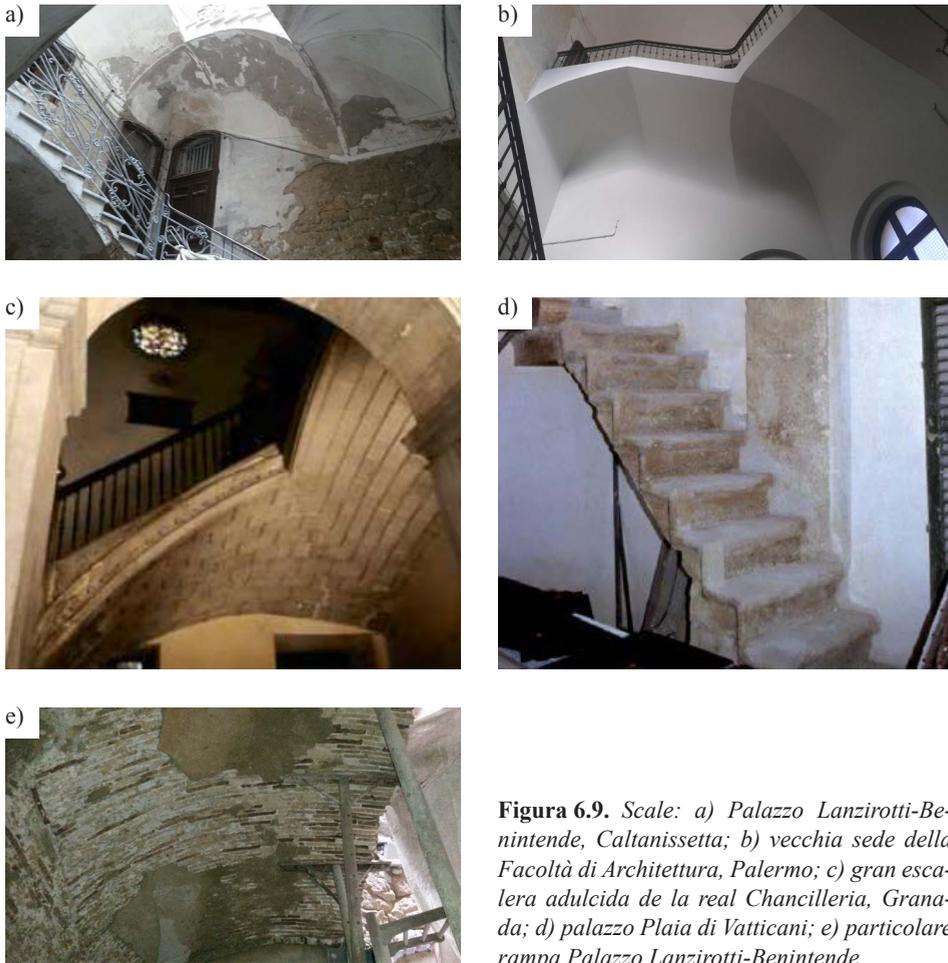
Scale: a) Palazzo Lanzirotti-Benintende, Caltanissetta; b) vecchia sede della Facoltà di Architettura, Palermo; c) gran escalera aduclida de la real Chancilleria, Granada; d) palazzo Plaia di Vatticani; e) particolare rampa Palazzo Lanzirotti-Benintende.
